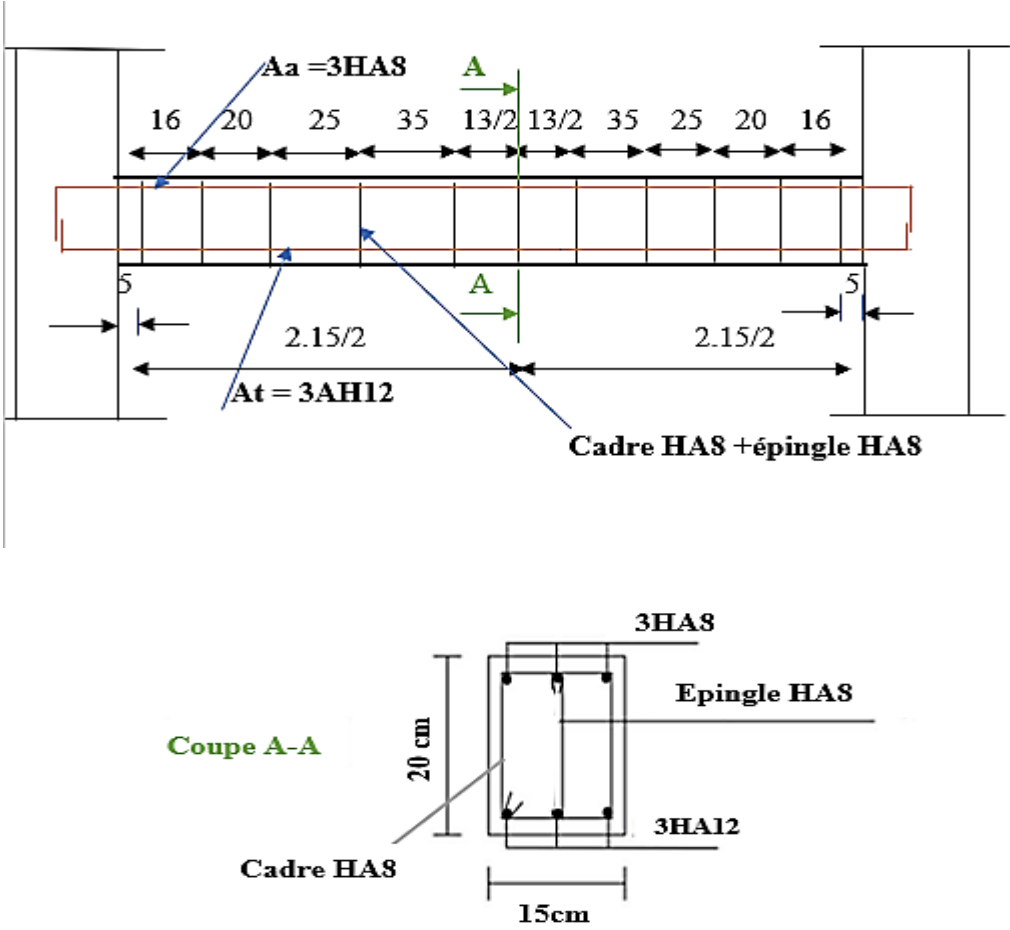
Schéma Ferrailage de la poutre palière
